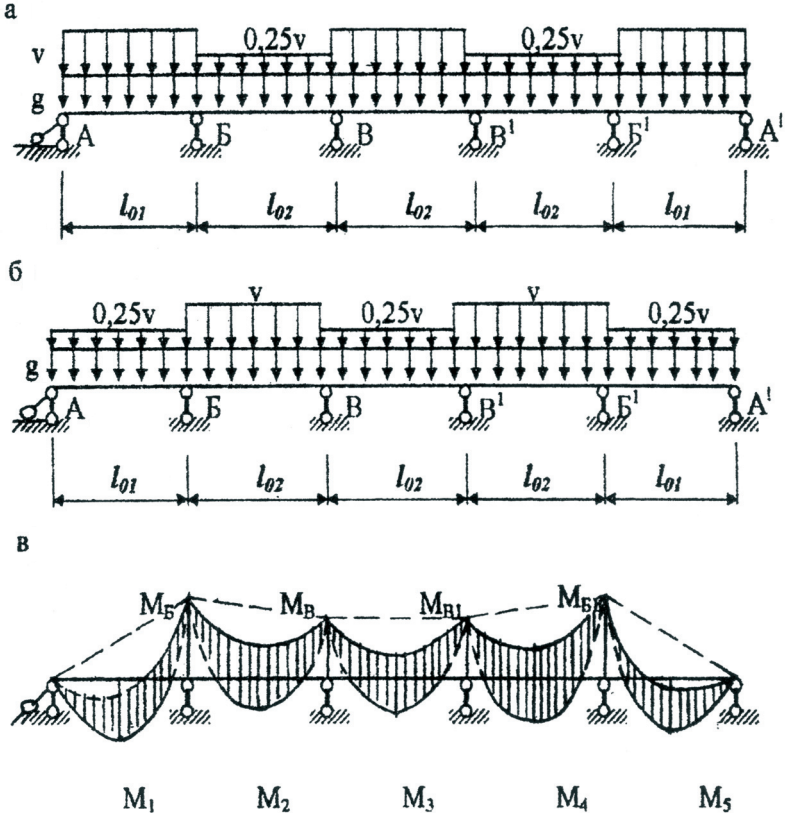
Схемы нагружения (а, б) и огибающая эпюра моментов (в) для второстепенной балки
